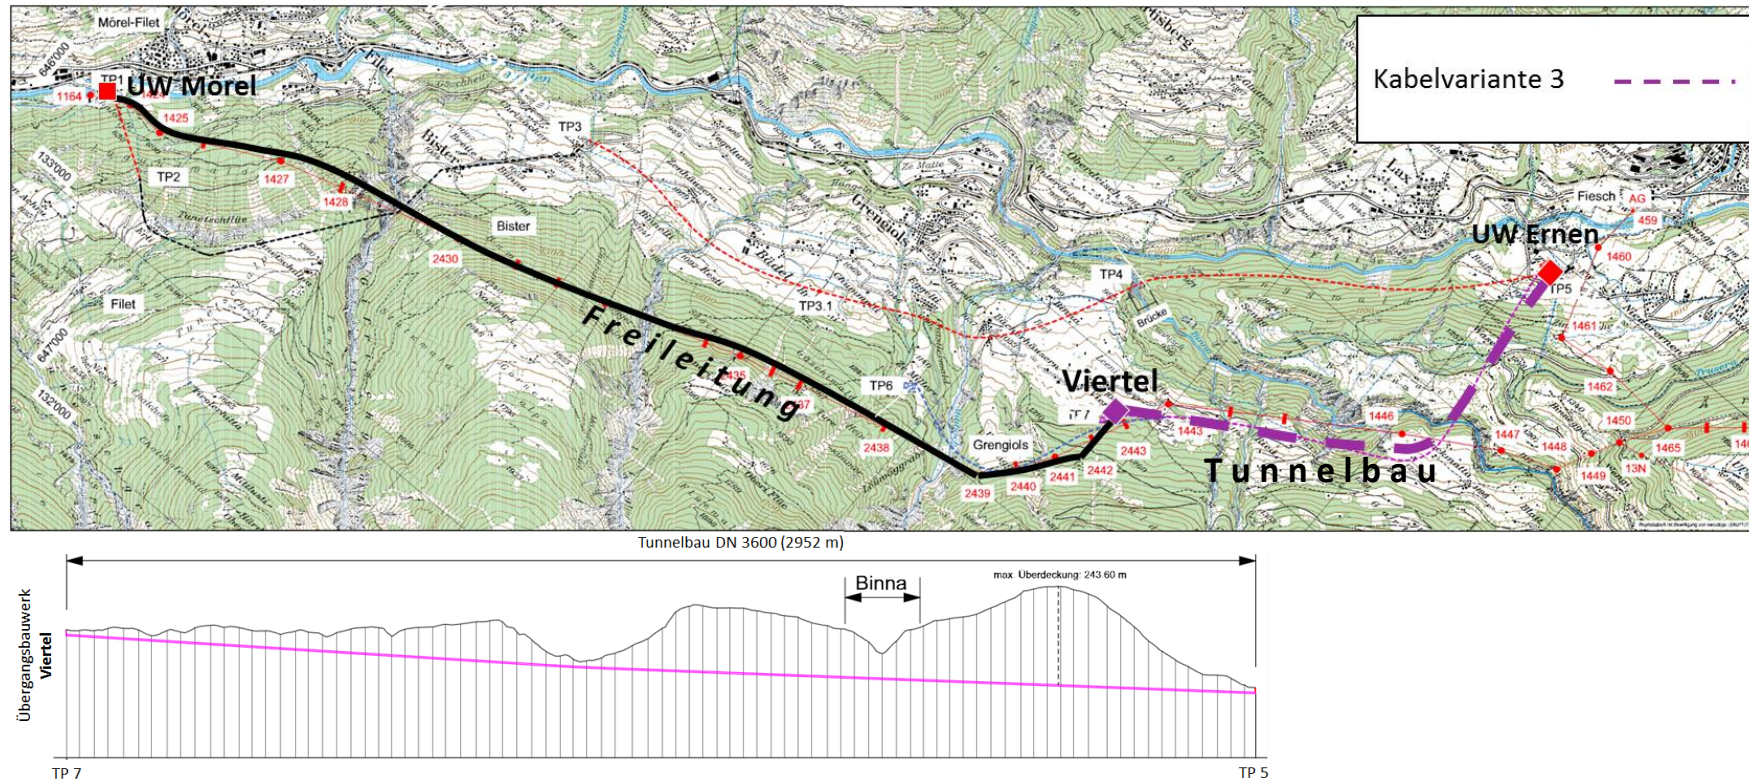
Skizzierung des Trassenverlaufs der Kabelvariante 3 im Lageplan (oben) und Höhenplan (unten)
